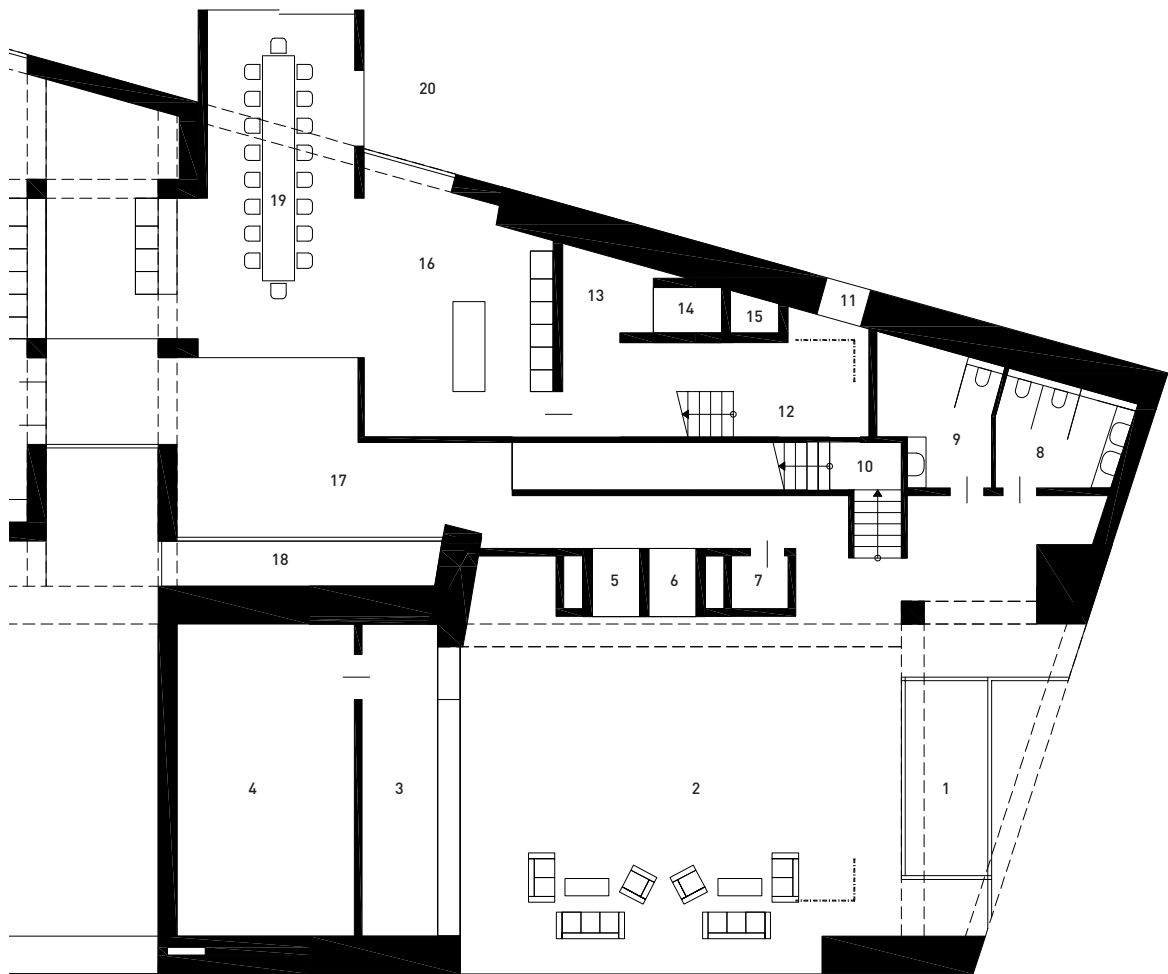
Grundriss Foyer Unterkunft M1:200
